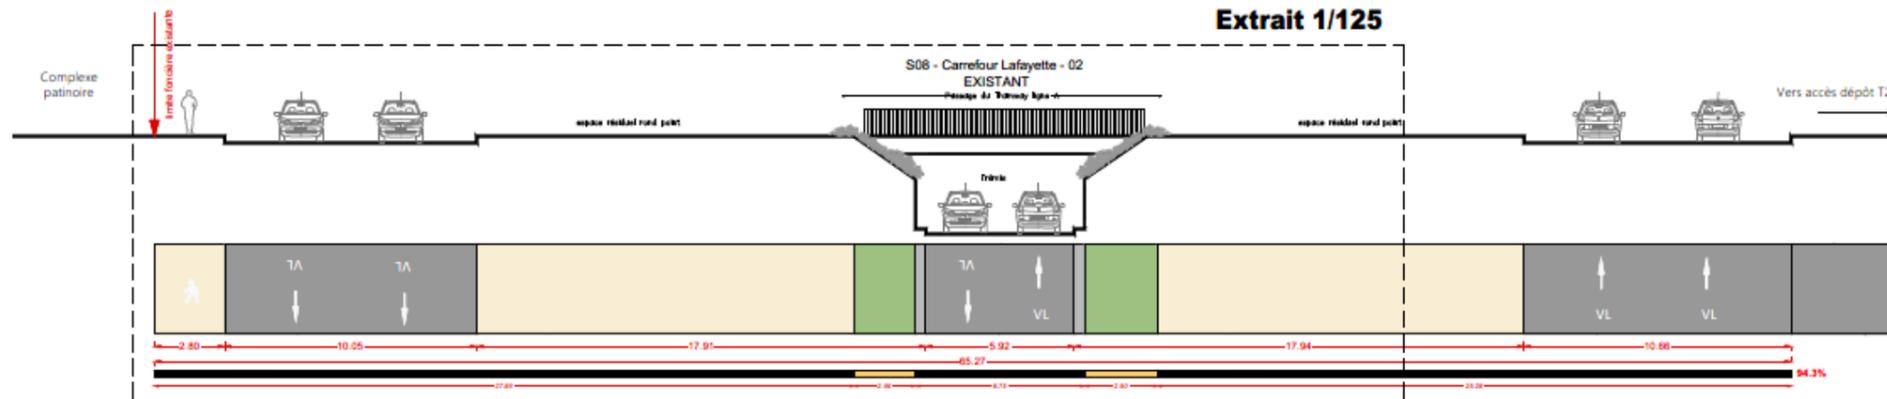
Profil existant sur le boulevard Schuman au droit du carrefour avec le boulevard Lafayette
